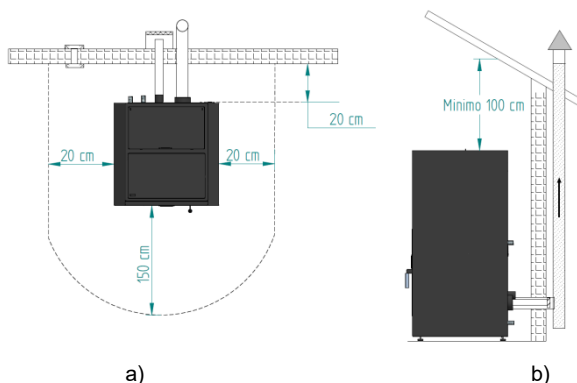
Distanze minime con tutte le superfici: a) vista dall'alto dell'installazione della caldaia; b) vista laterale dell'installazione della caldaia
